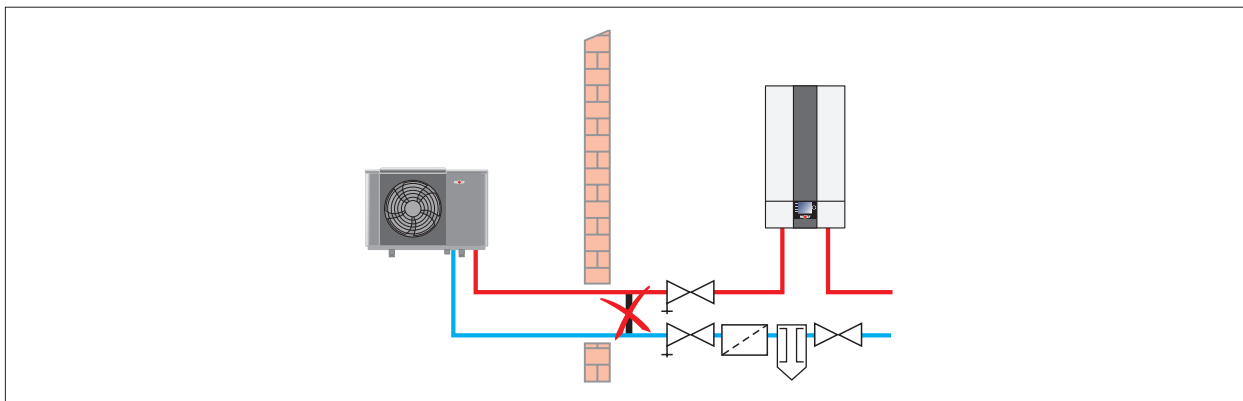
Prestavba hydraulického pripojenia vonkajšej jednotky
